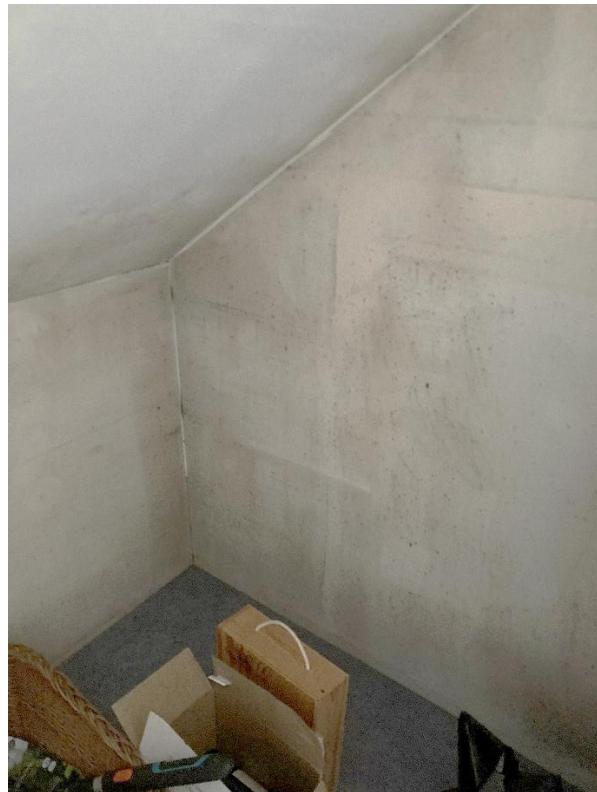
local dénommé grenier sur le plan (vue sur angle cloison orientée SO et façade orientée NO)
